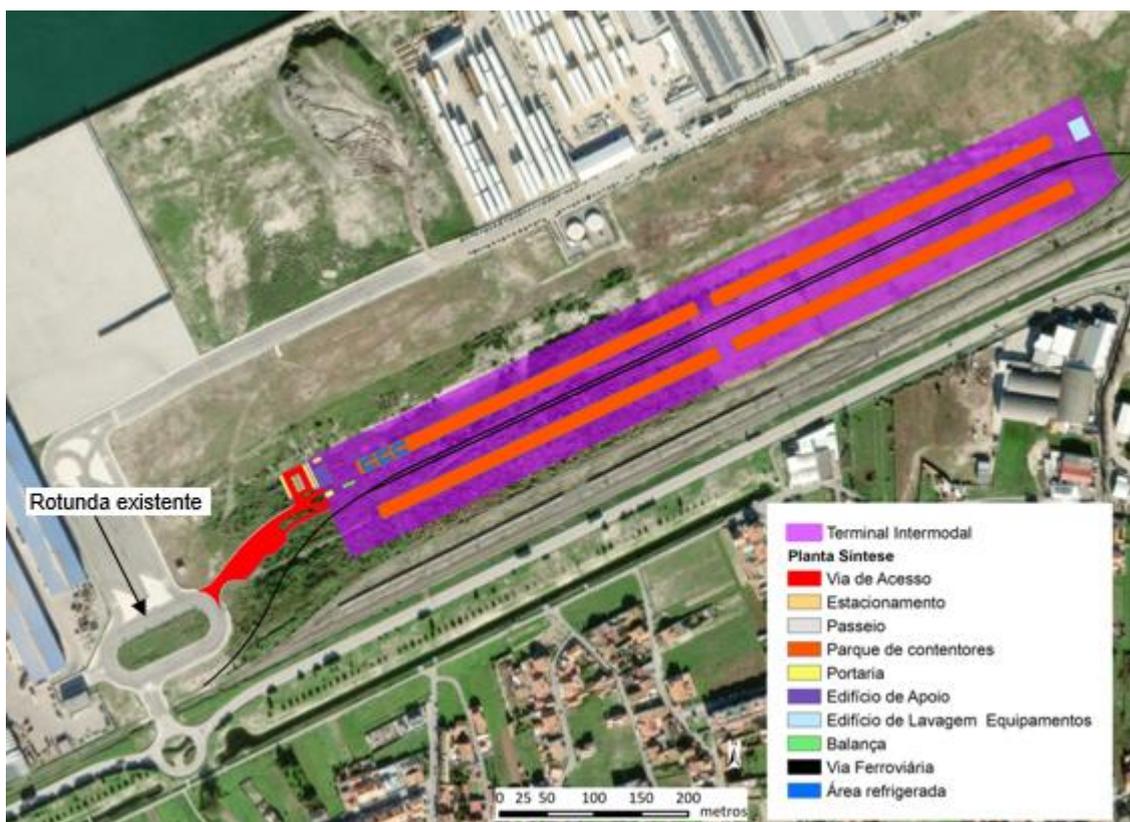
Pormenor da implantação do projeto sobre imagem aérea.
